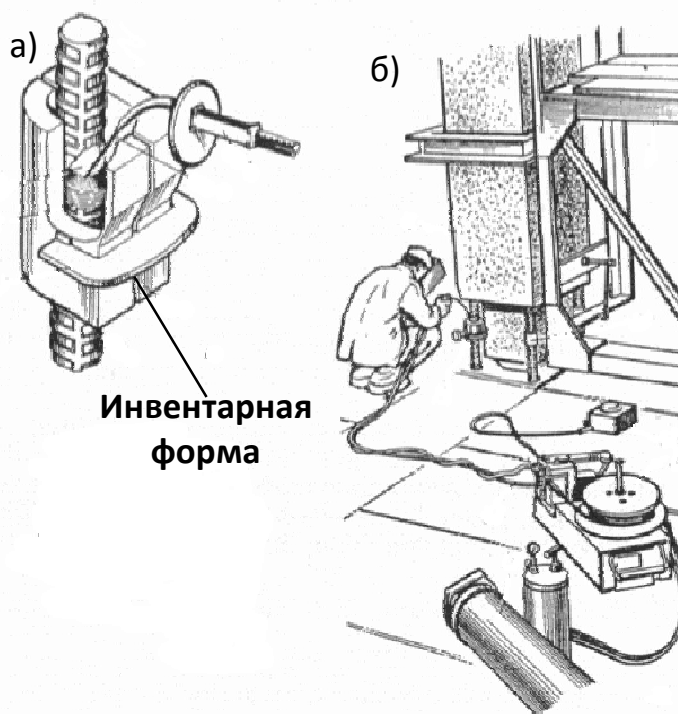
Схема (а) и общий вид (б) процесса ванной сварки вертикальных стыков стержней арматуры
